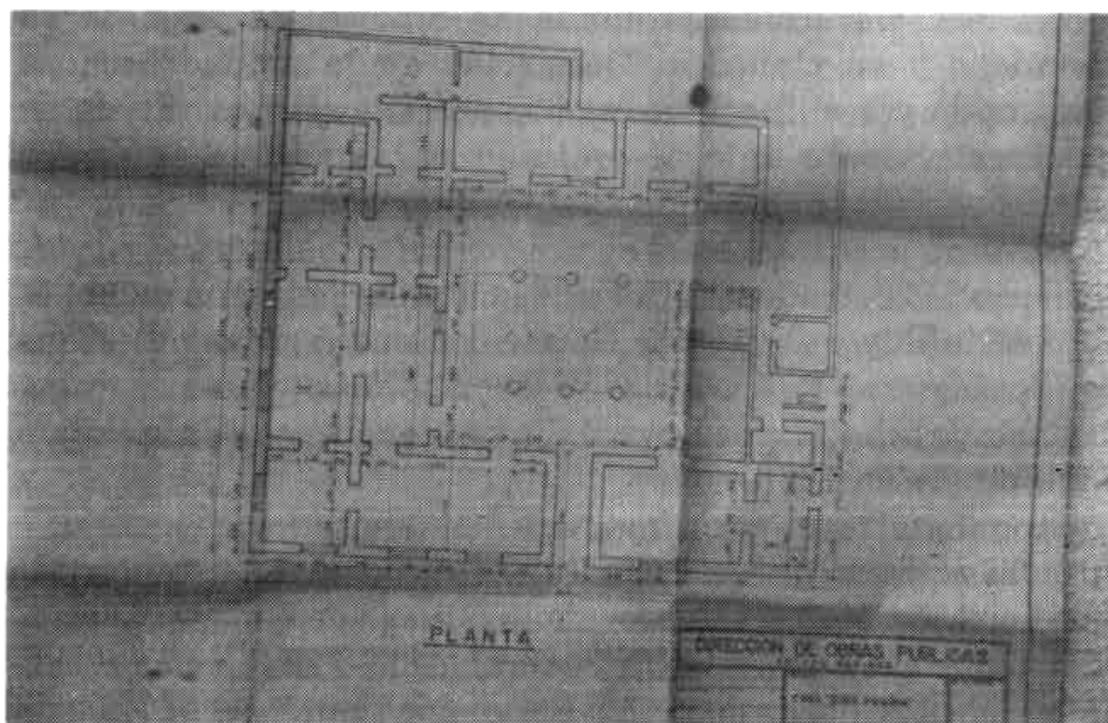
Planta de la casa Pulido. Levantamiento del MOP.
